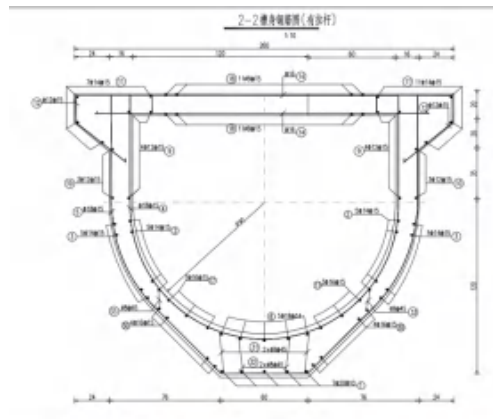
渡槽跨中段钢筋剖面图（有拉杆处）2-2 剖面
